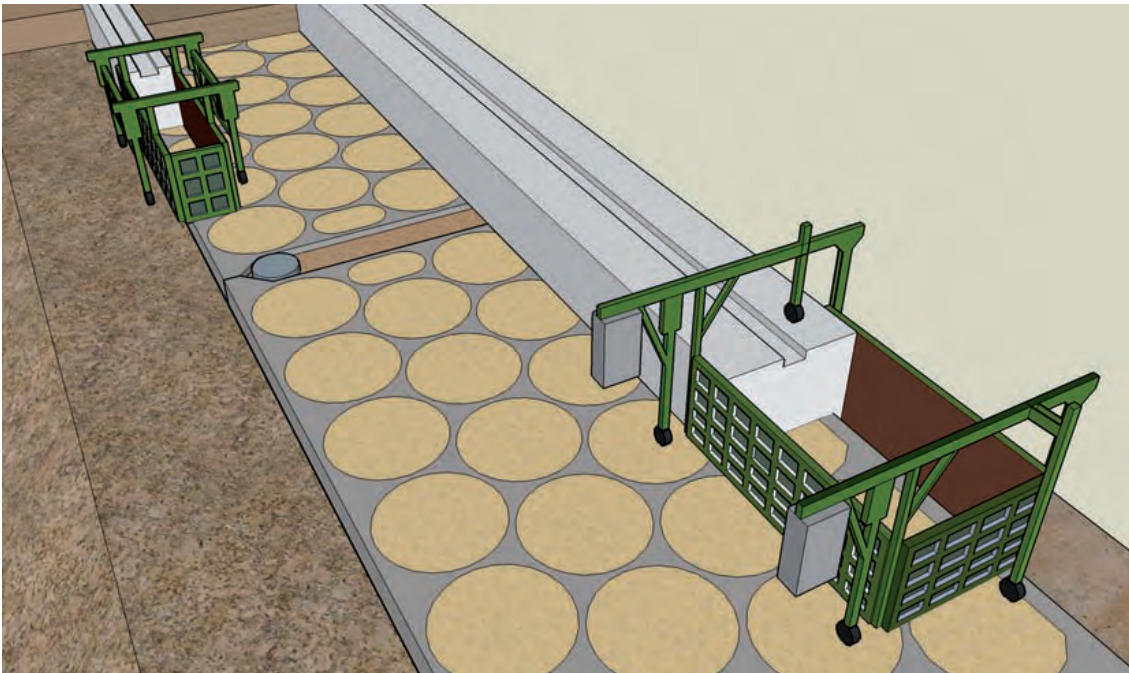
B *Desfase entre vigas trasera y cantil
